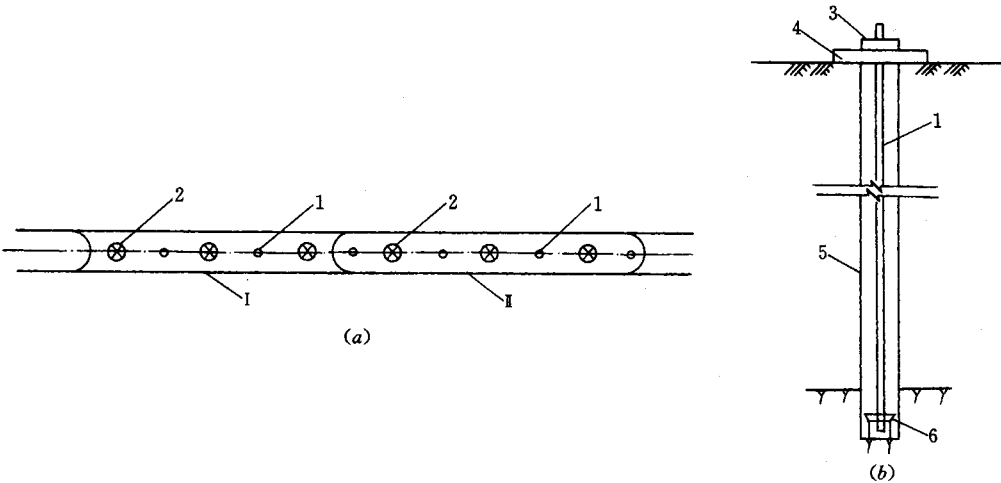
无钢筋笼预埋管布置与定位示意图
